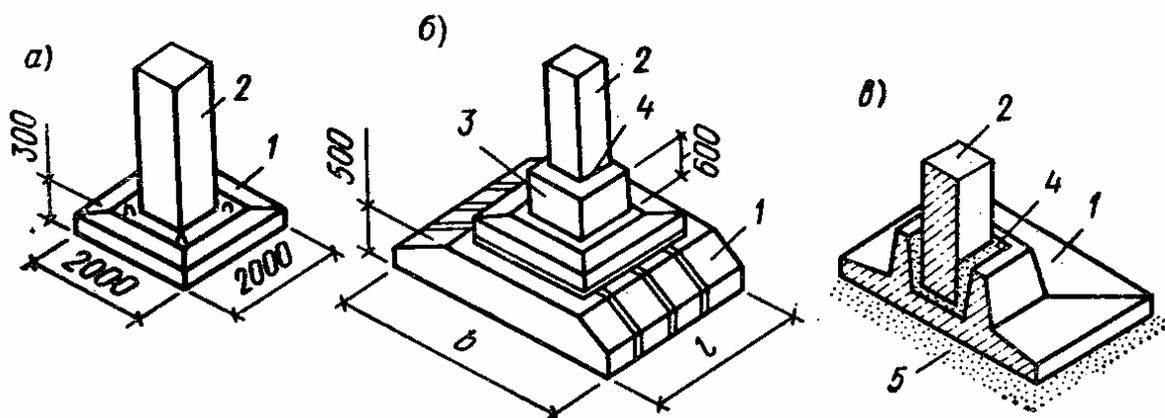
Сборные столбчатые фундаменты многоэтажных зданий:
